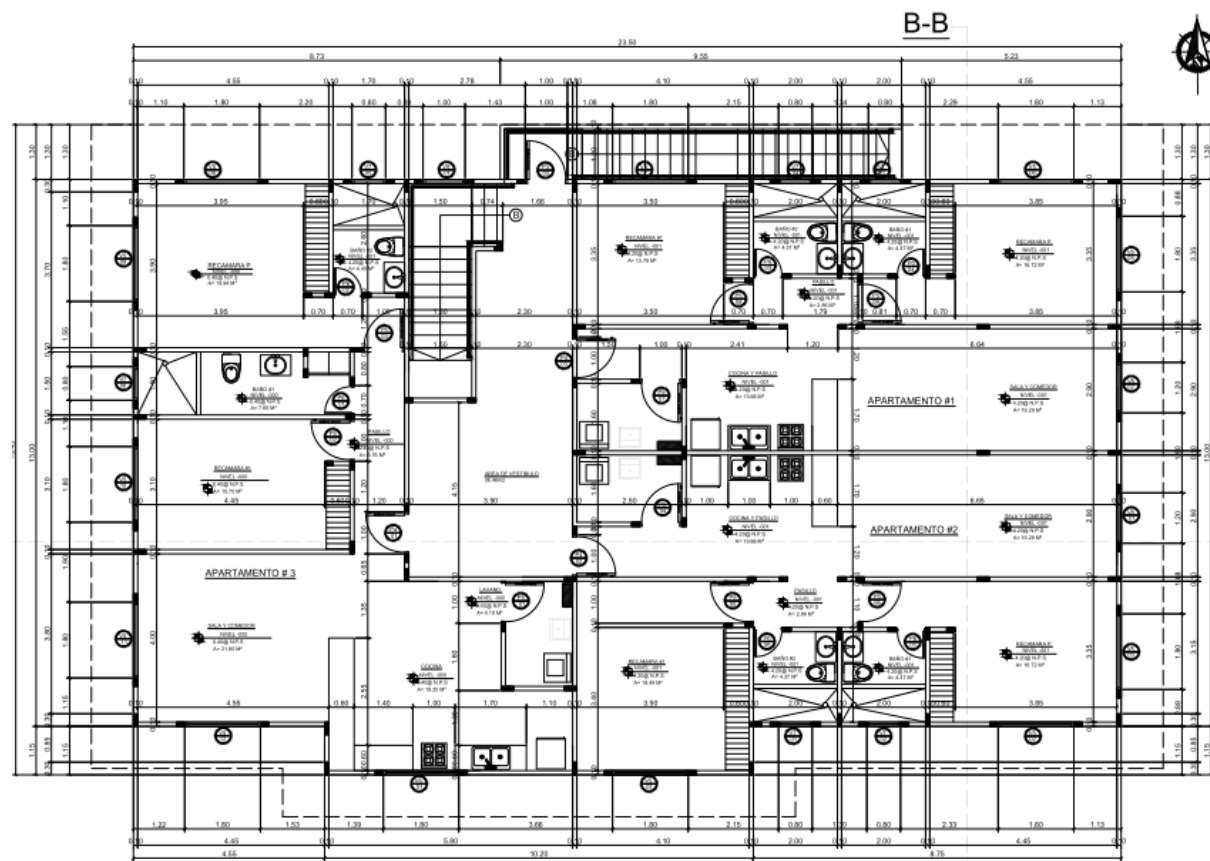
PLANTA ARQUITECTÓNICA – NIVEL 01
